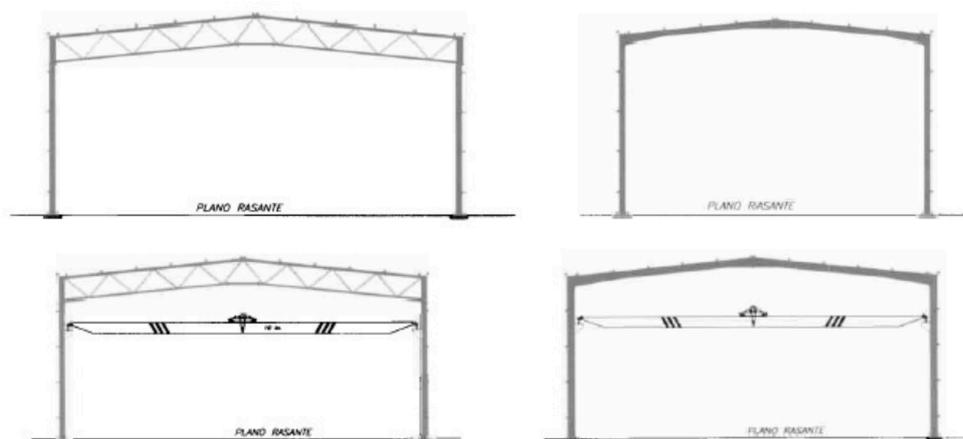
Naves industriales en planta baja y naves industriales con puente grúa.
